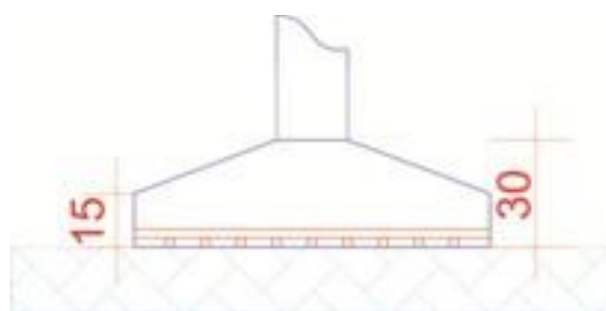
Vista em corte, destacando a altura das sapatas. Fonte: Autor, 2019
